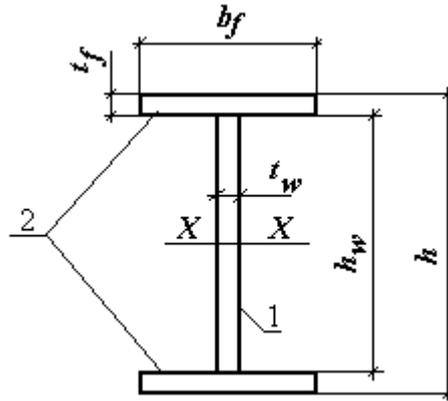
Параметры сечения составной балки (1-стенка, 2-пояса)
